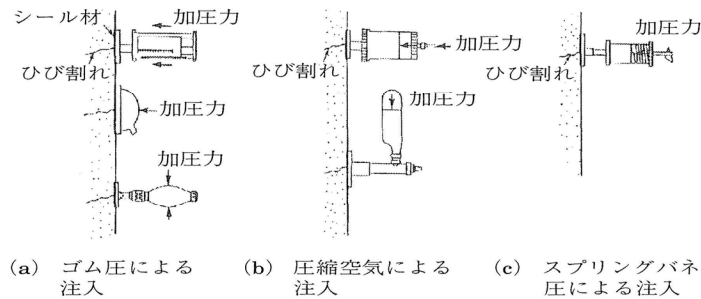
ひび割れ注入工法の施工例（低圧注入）
